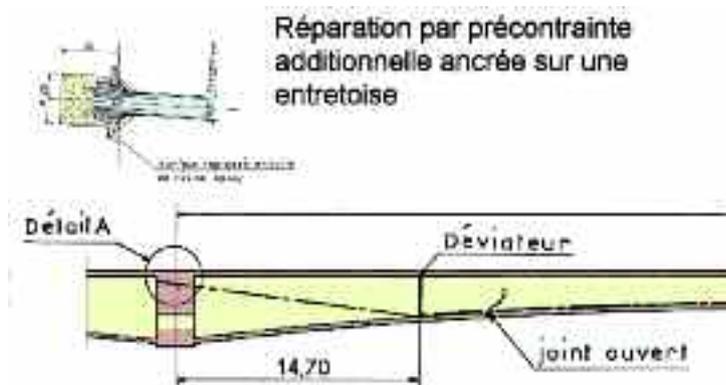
appui direct des ancrages sur l'entretoise intermédiaire du pont d'Aurec
